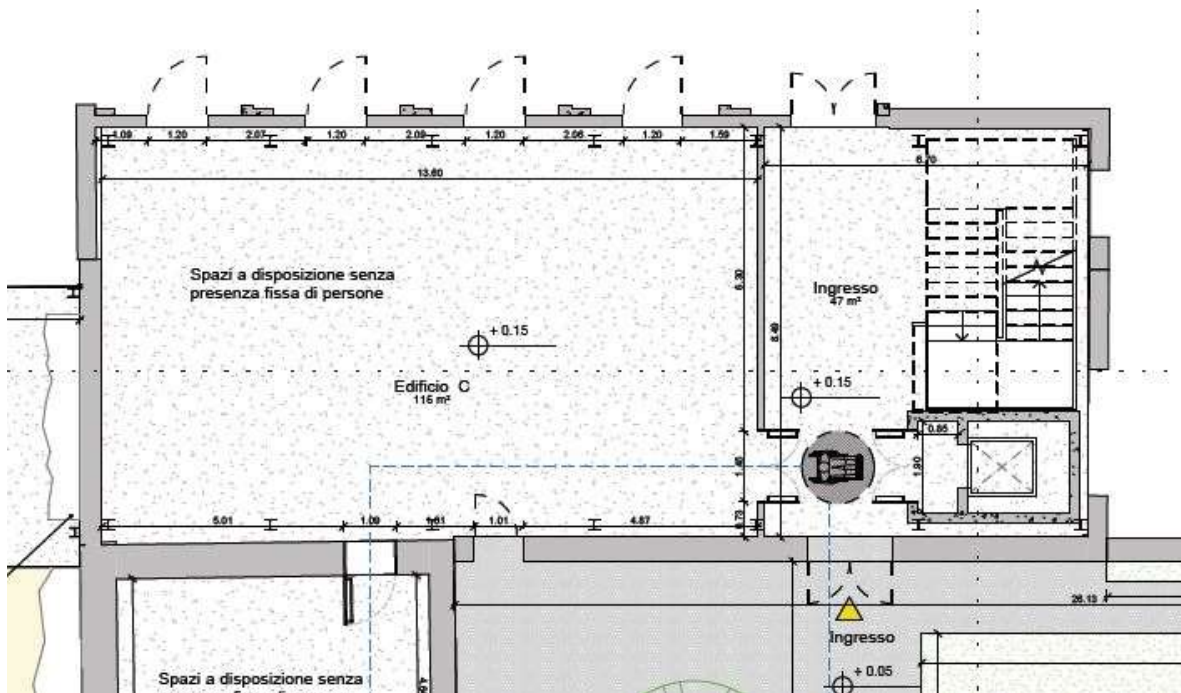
Ex-Galoppatoio - pianta piano terra Edificio 1
